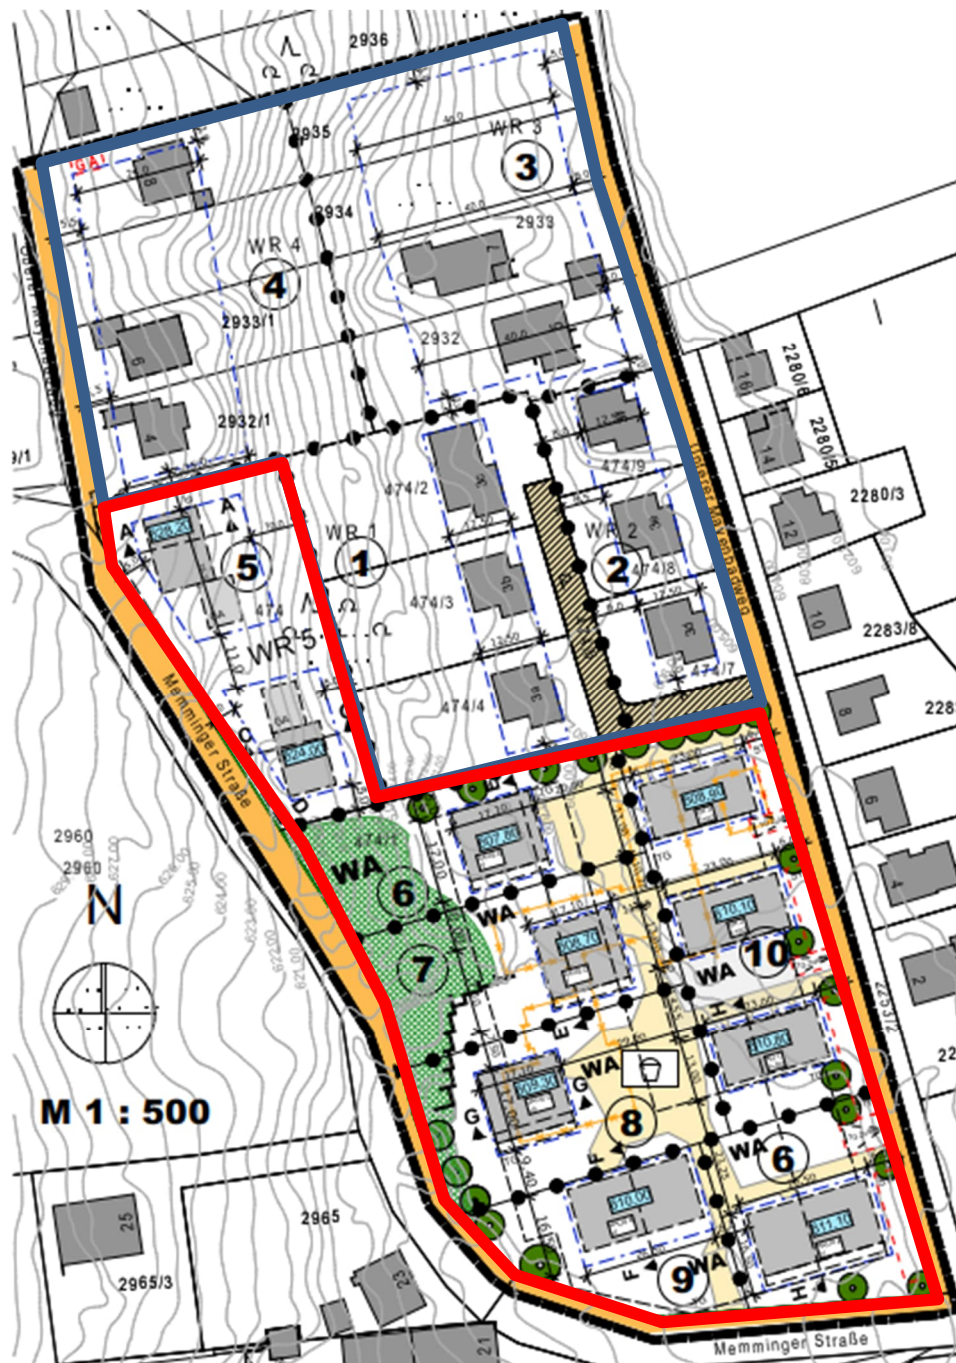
Entwurf des zu ändernden/aufzustellenden Bebauungsplans gemäß [a]
